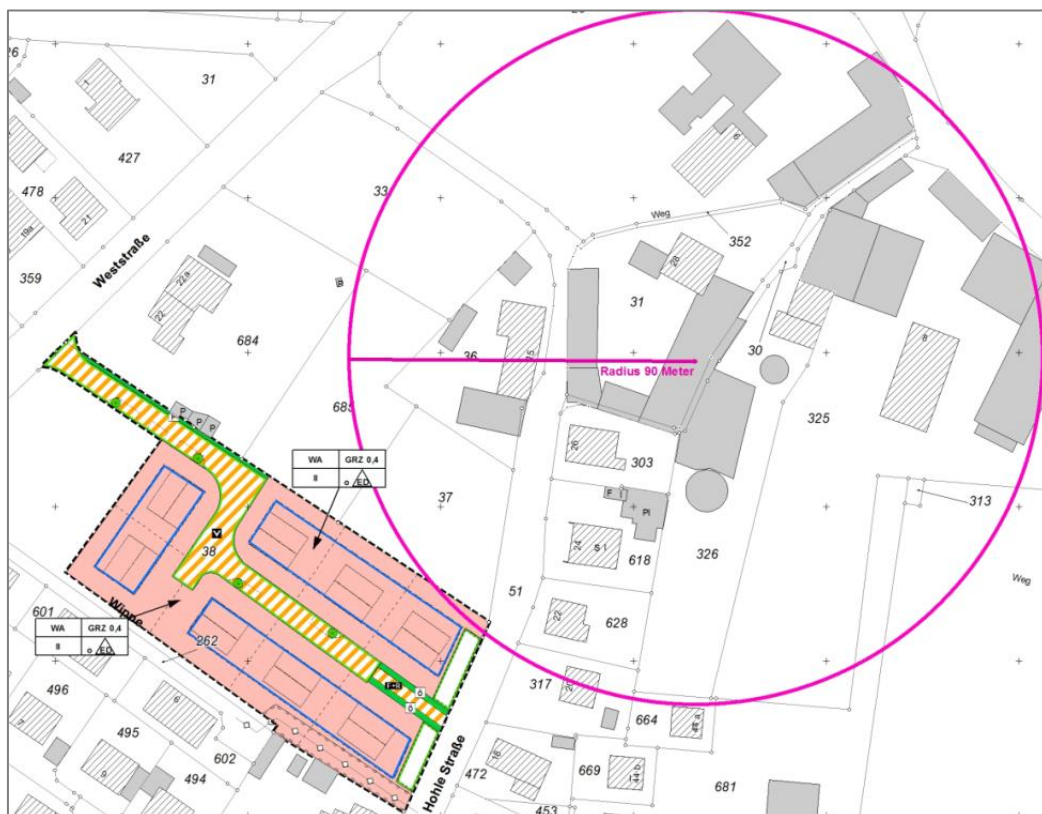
Übersichtsplan Werl-Westönnen Weststraße / Hohle Straße mit 90m-Radius um Immissionsschwerpunkt (ohne Maßstab)
